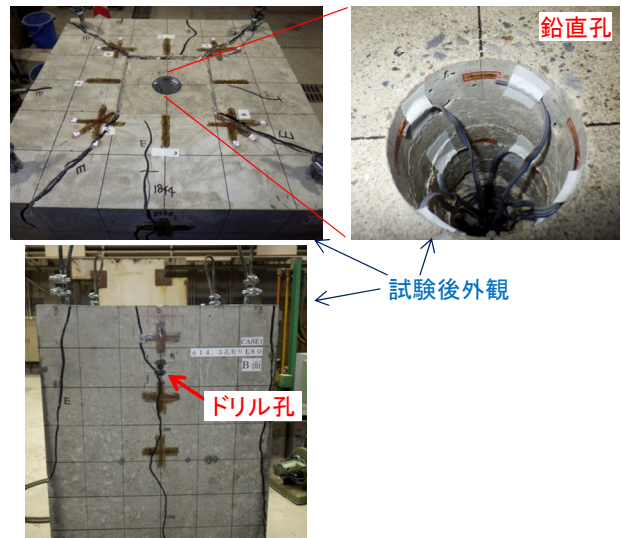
供試体 D-80 の試験後のひび割れ状況
